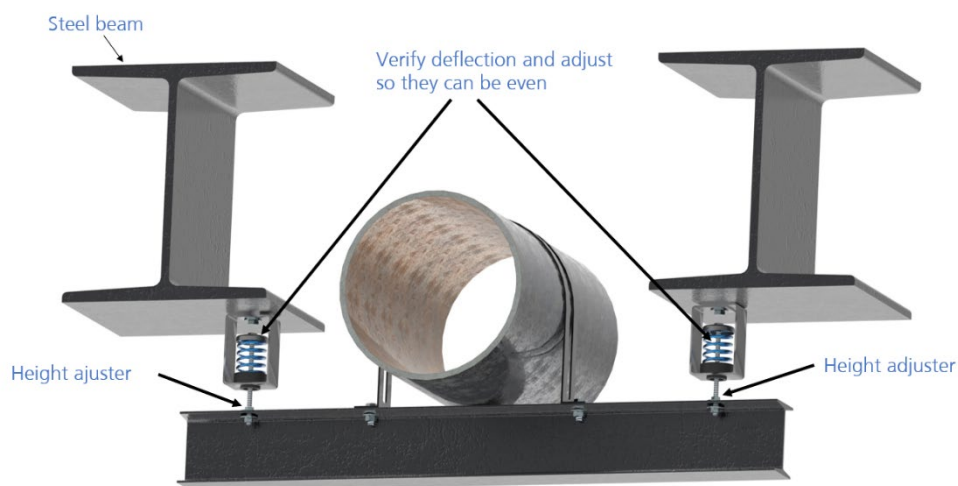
Sospensione del condotto mediante l'installazione di un telaio metallico sulla trave in acciaio.
